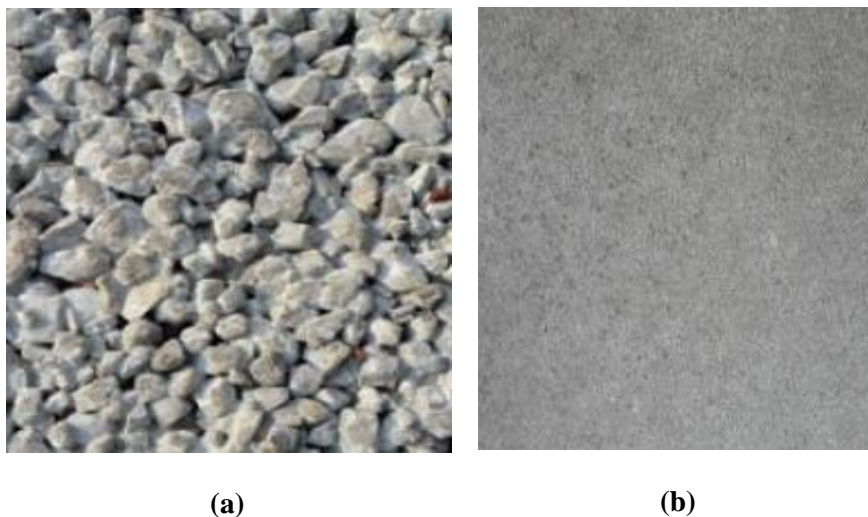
(a) Textura do concreto permeável e (b) do concreto convencional vista do topo (MULLIGAN, 2005).
